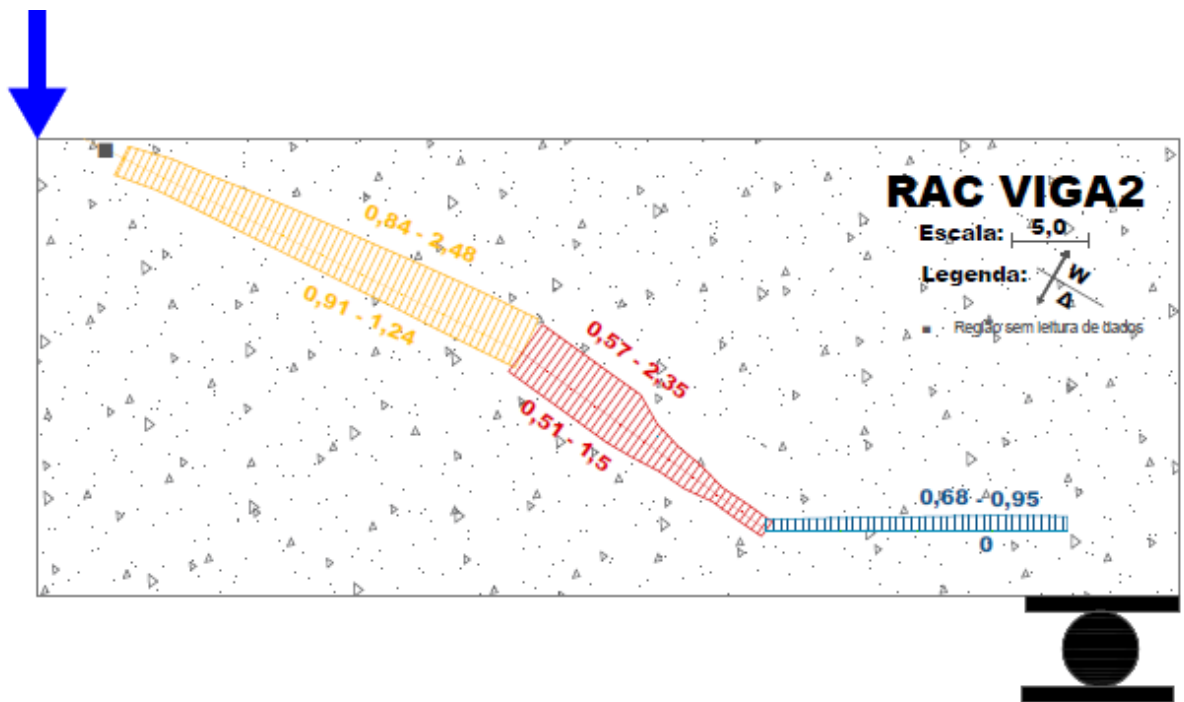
Abertura (w) e deslizamento (Δ) da fissura diagonal crítica da viga RAC-2.
